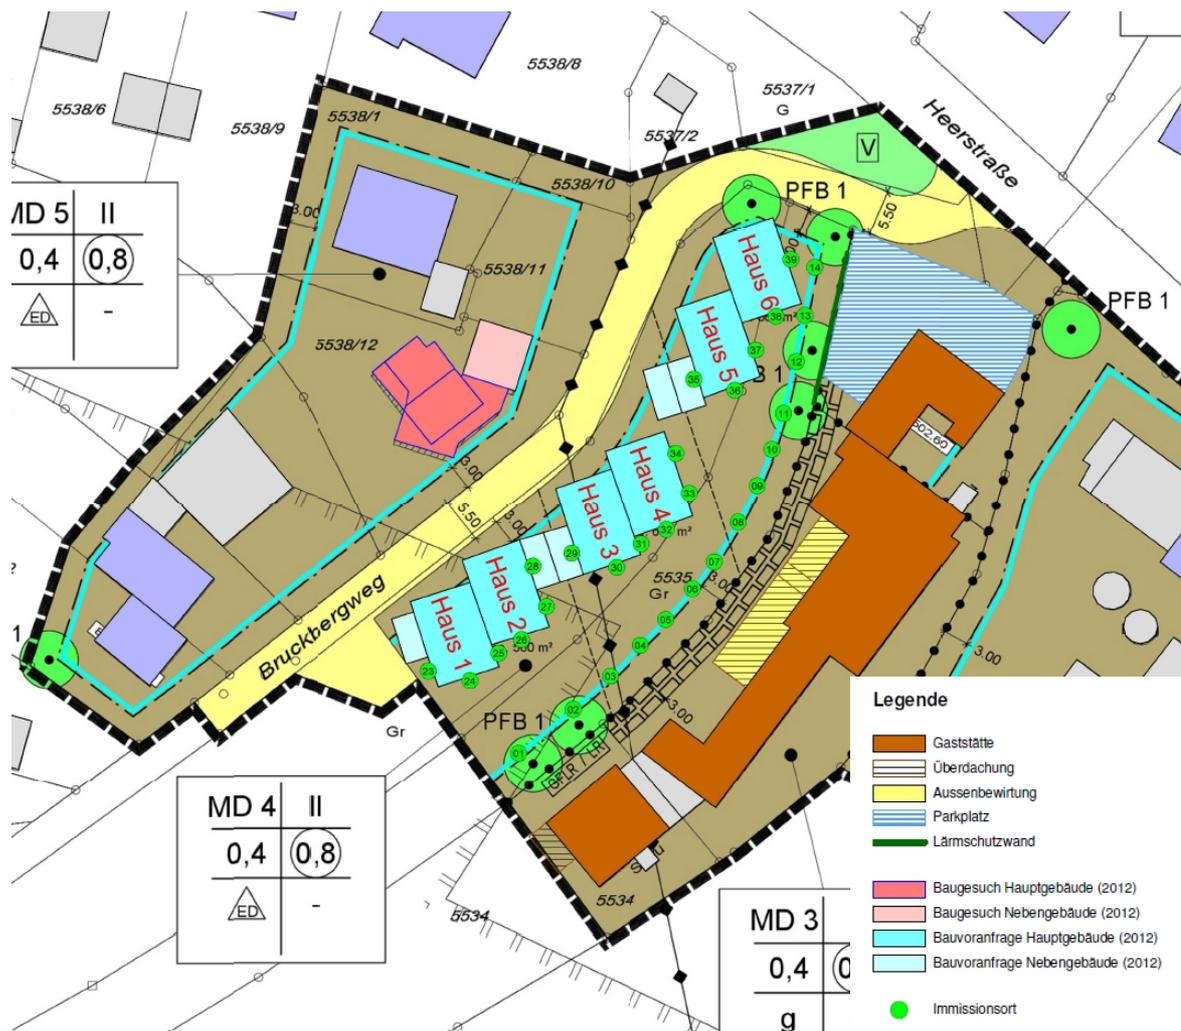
Schalltechnische Untersuchung, Immissionsorte, Schallquellen und Lärmschutzwand (unmaßstäblich, Stand 27.06.2017)
